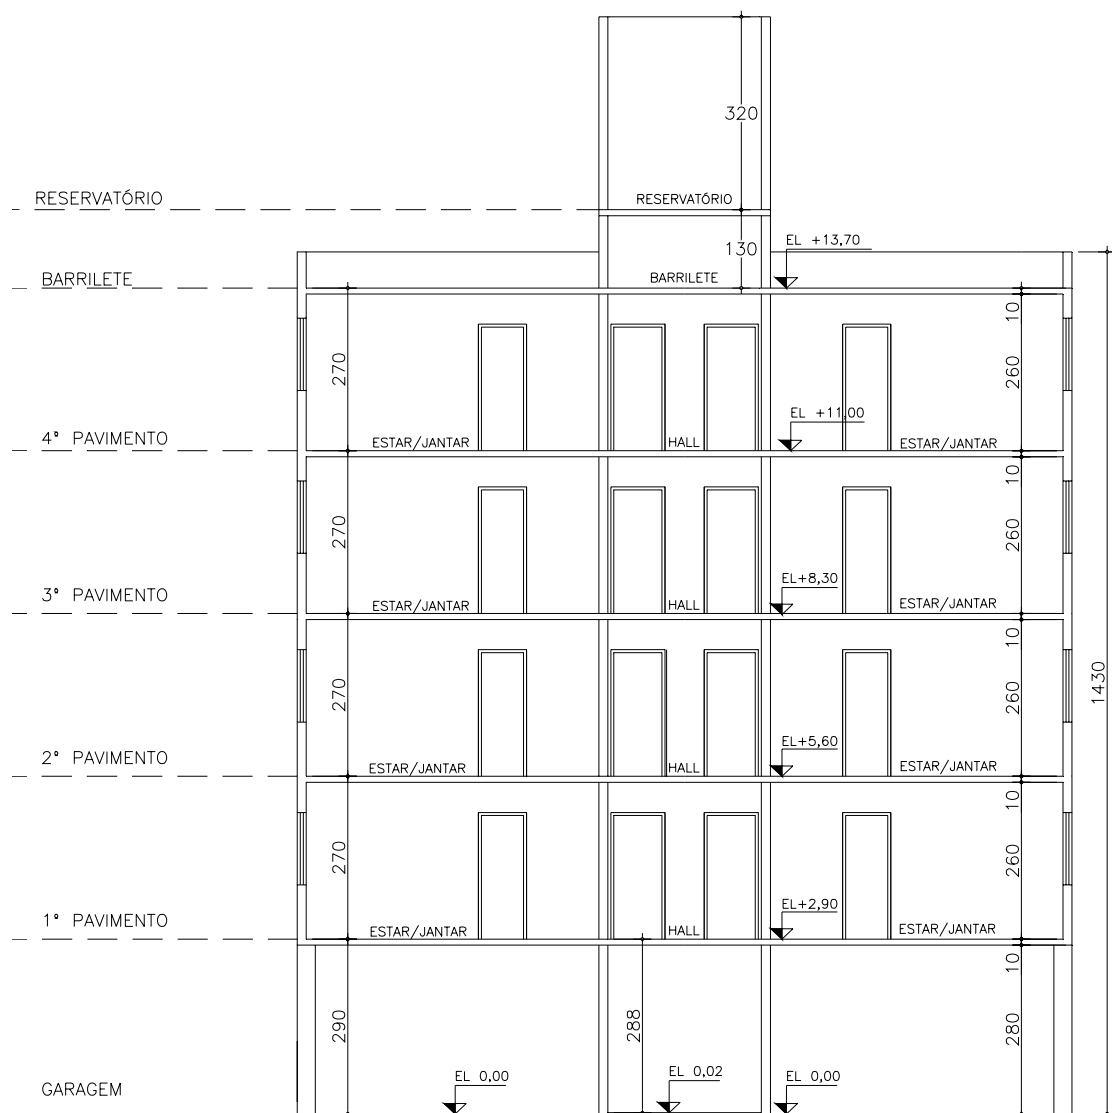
Prédio “M” – Corte esquemático longitudinal A-A
